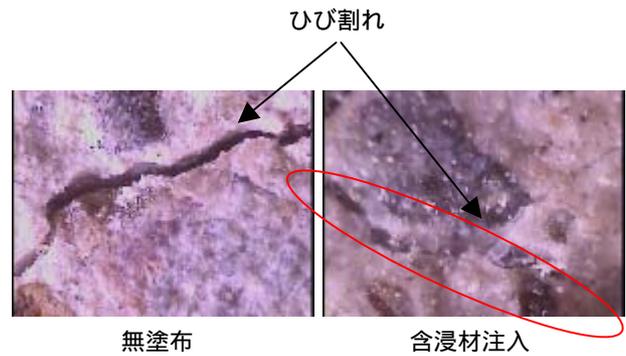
表面含浸材を注入した供試体のひび割れ閉塞状況（ひび割れ幅0.1mm）
